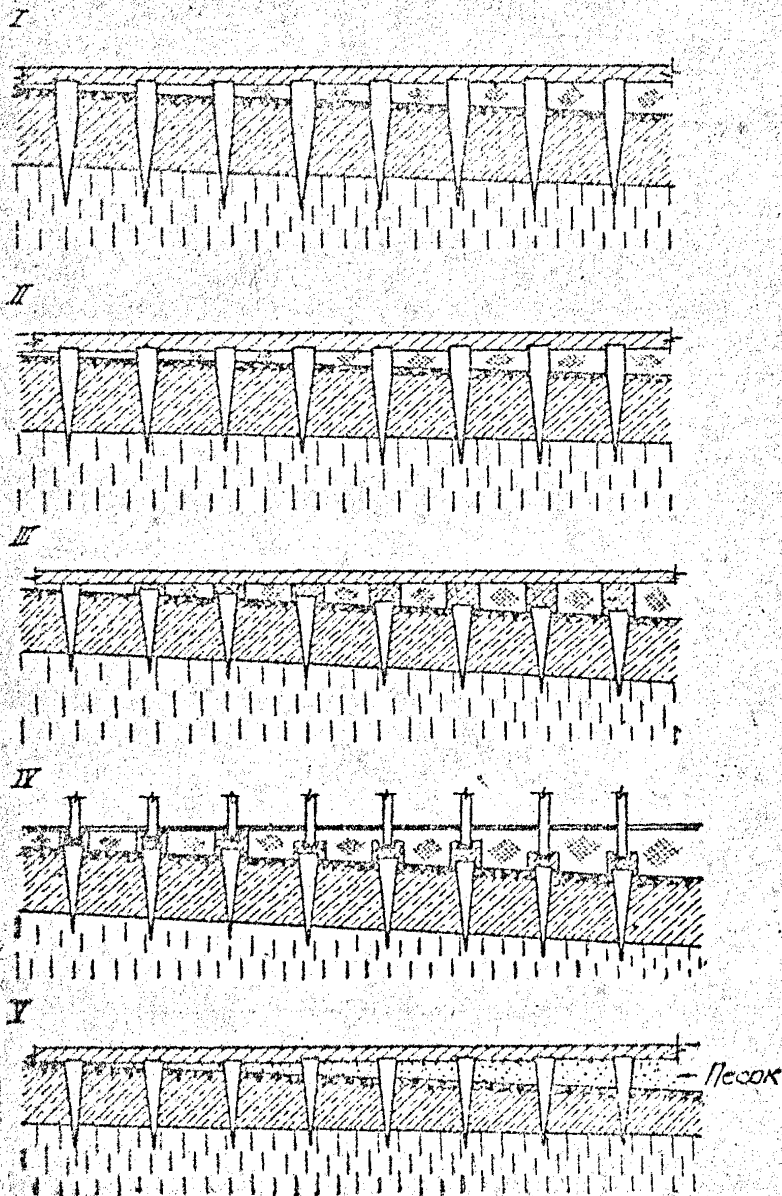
Способы устройства свайных фундаментов из пирамидальных свай на косогоре.
